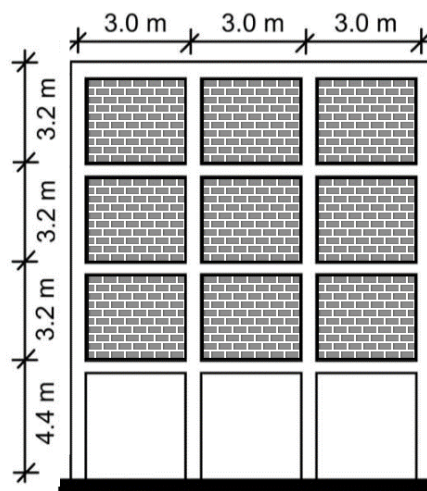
Configuración del edificio de planta baja blanda (Kaushik *et al.* 2009)
